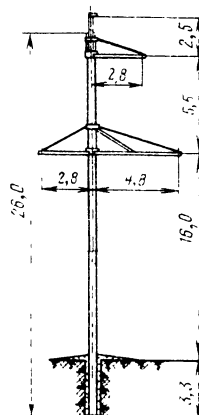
Железобетонная промежуточная двухцепная опора ВЛ 220 кВ
